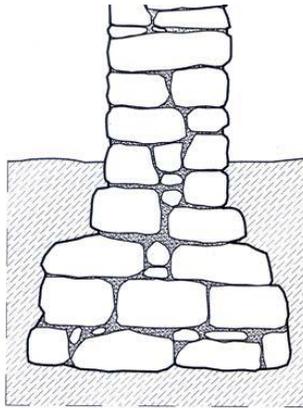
Zapata corrida bajo muro. 2011. Google.
